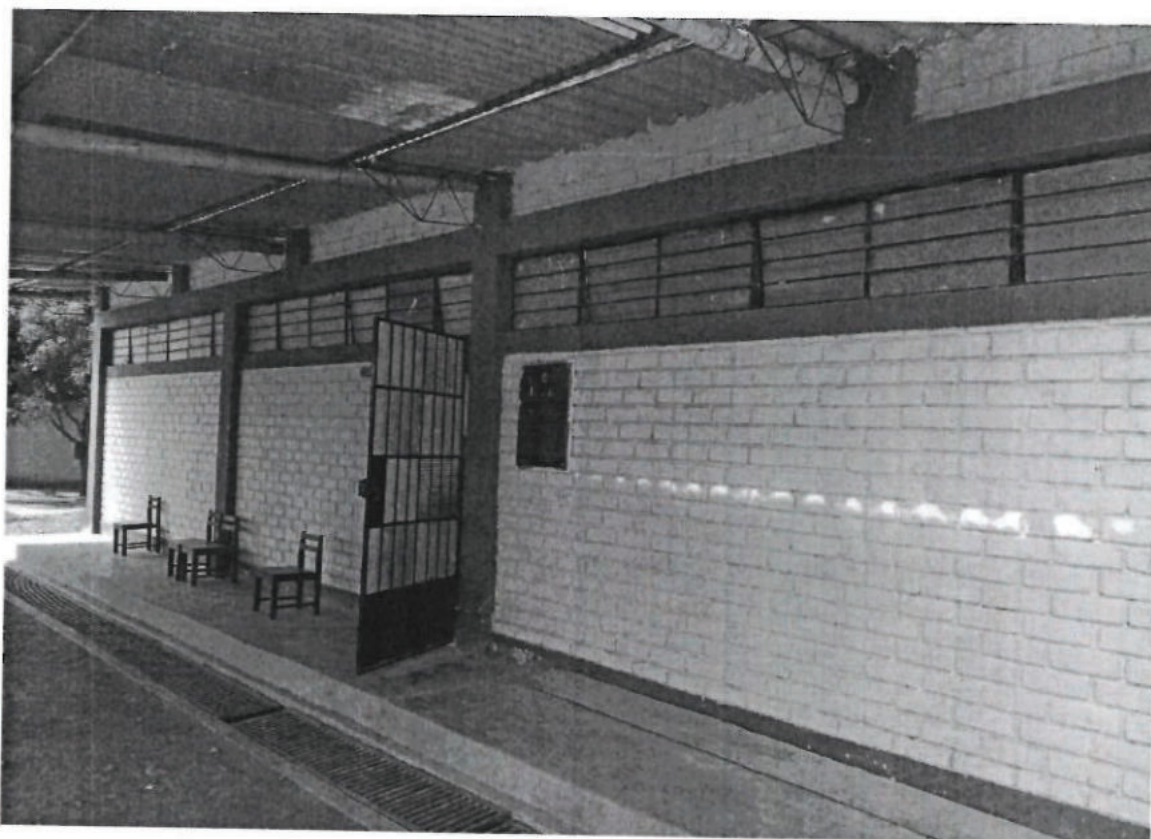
(Vista Interior) No presenta fisuras, grietas, asentamiento, ni ningún otro tipo de daños graves que hayan afectado los elementos estructurales.
